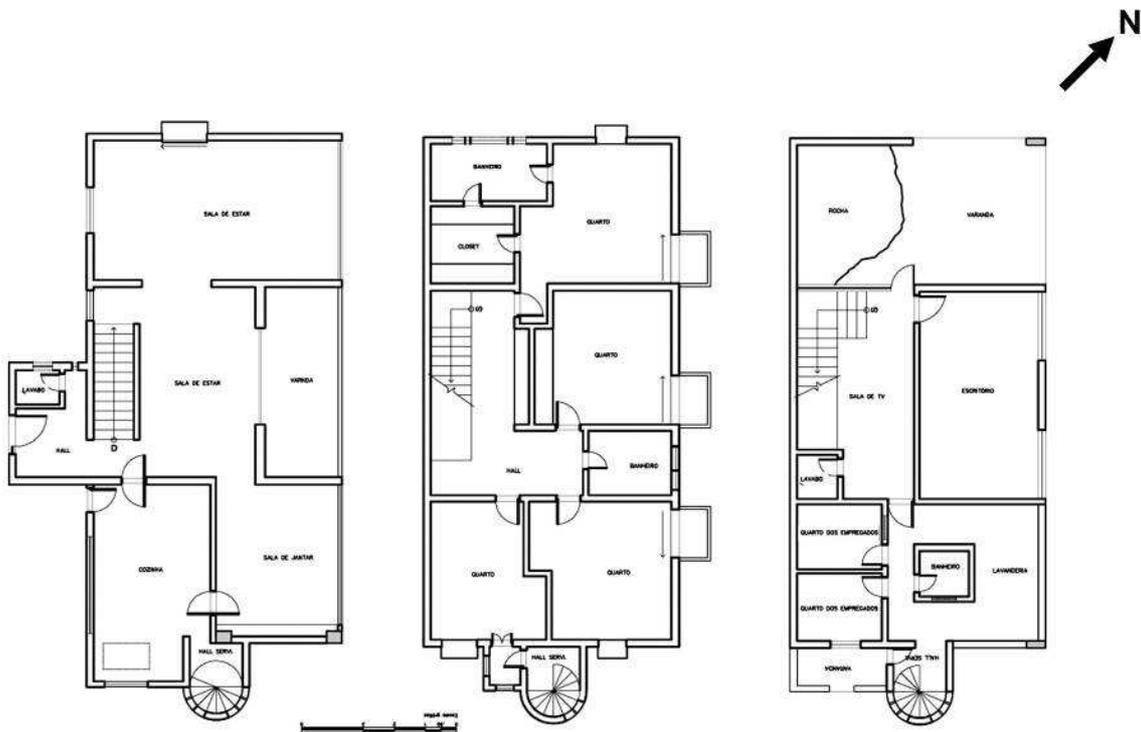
Plantas baixas dos terceiro, segundo e primeiro pavimentos
